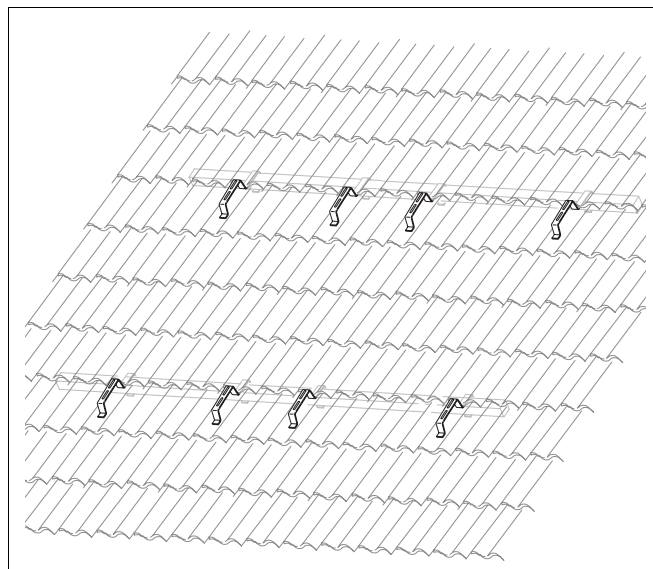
Vista de ganchos para tejado colgados y complementos de ganchos de tejado
